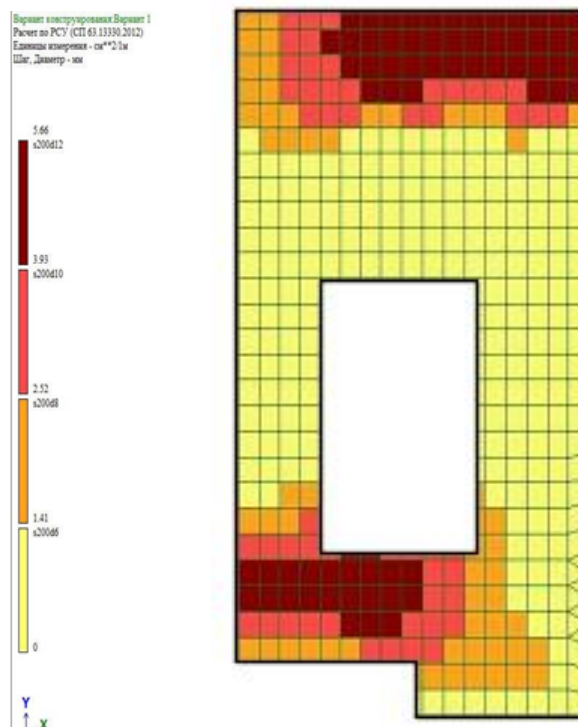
Площадь требуемой арматуры на 1 пм по оси Y у нижней грани
